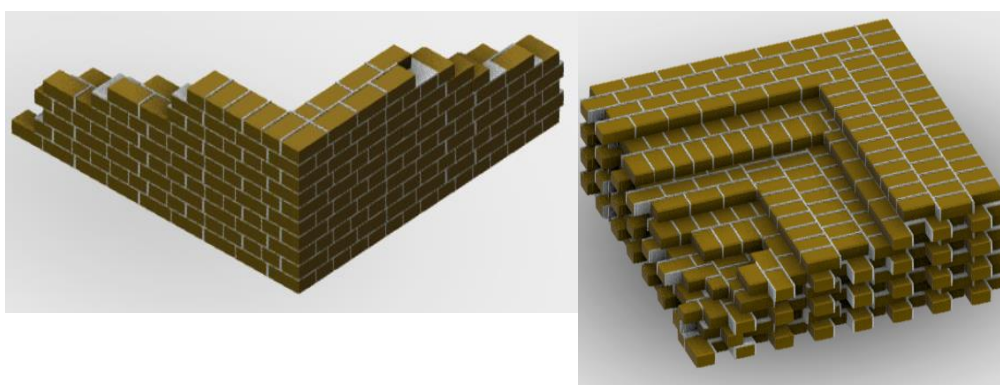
Detalle de construcción del muro de mampostería de ladrillo Contemporáneo. En las columnas y torre superior (izquierda) y base de la torre (derecha).
